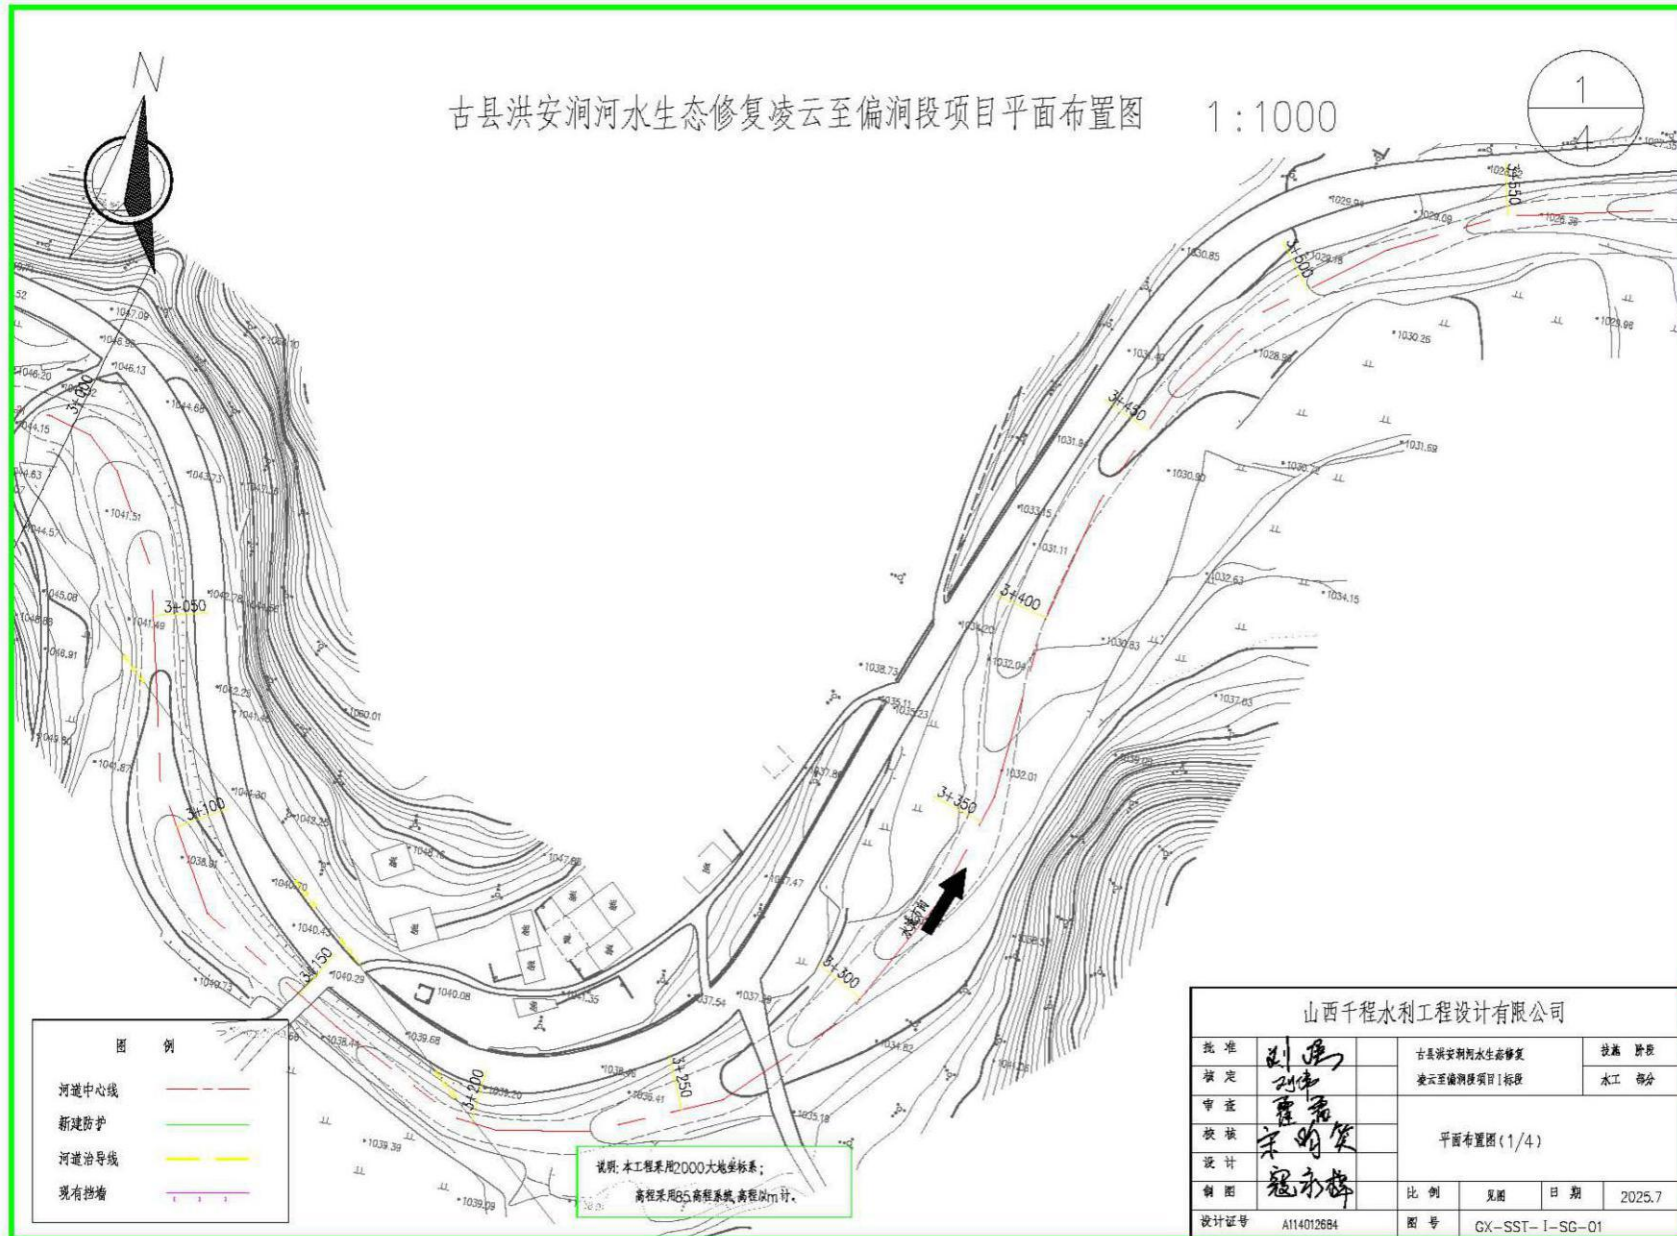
(1) 工程总平面布置图(桩号 3+000-3+600)
